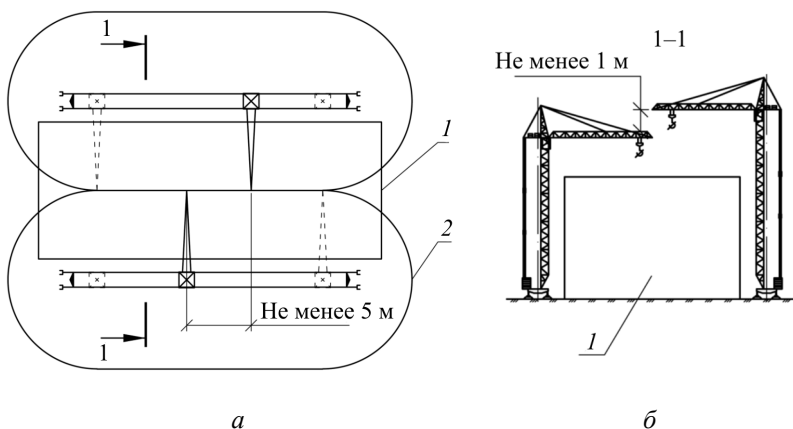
Схема организации работы двух кранов в плане (а) и в разрезе (б): 1 – возводимое здание; 2 – рабочая зона крана
